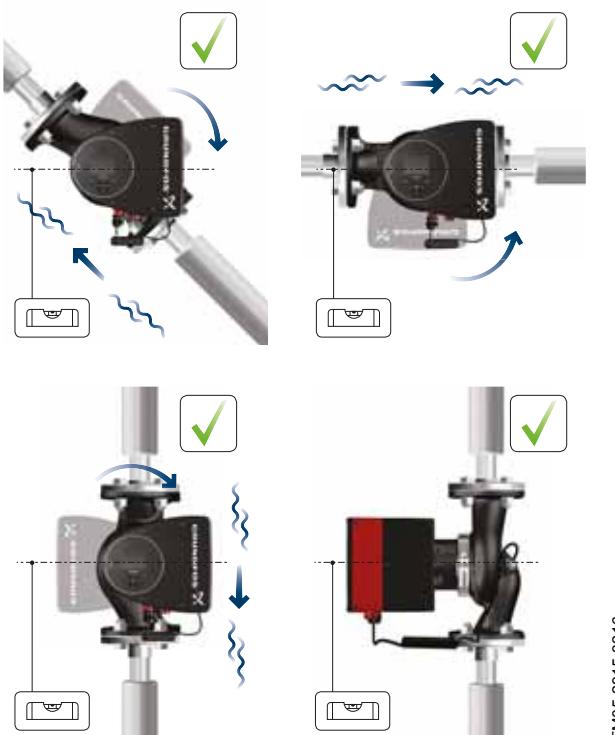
Bomba instalada con el eje del motor en posición horizontal
